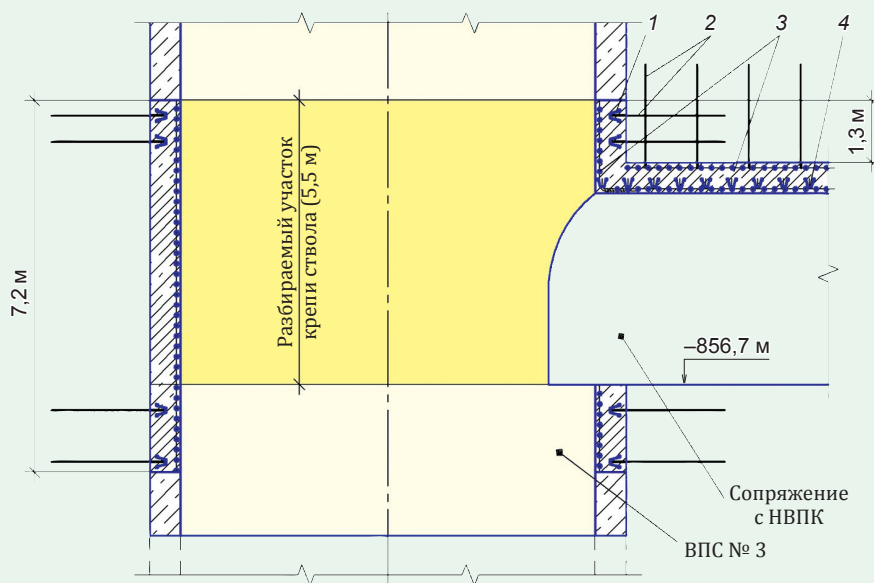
Разрез по сопряжению ствола ВПС № 3 с НВПК: 1 – усиливающие кольца из профиля СВП-33; 2 – сталеполимерные анкеры длиной 2,9 м; 3 – каркас железобетонной крепи; 4 – арочная крепь выработки.
